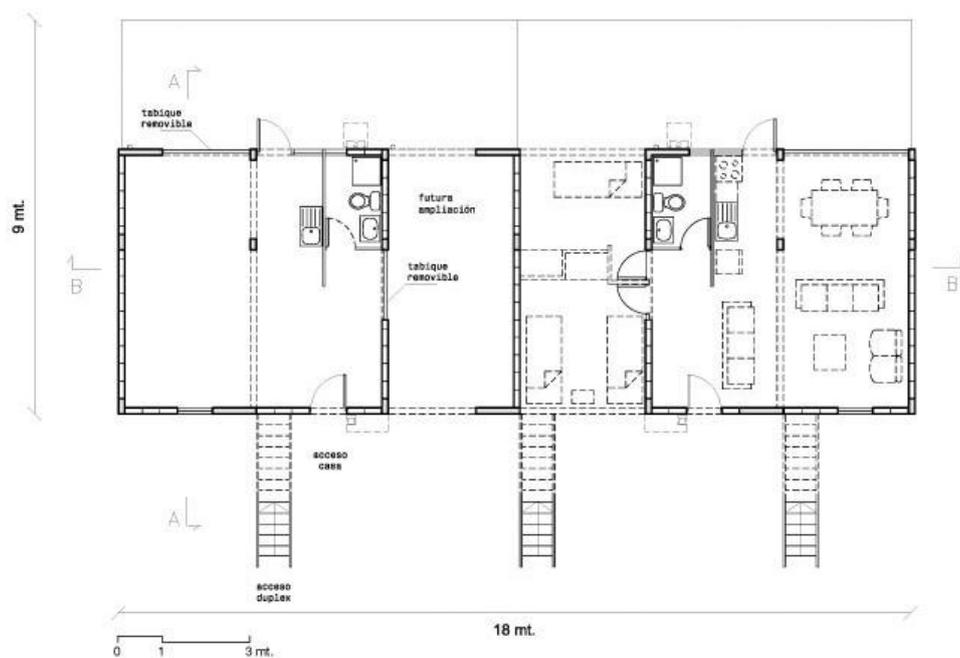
Planta baixa, primeiro piso. Projeto Elemental para Quinta Monroy.
